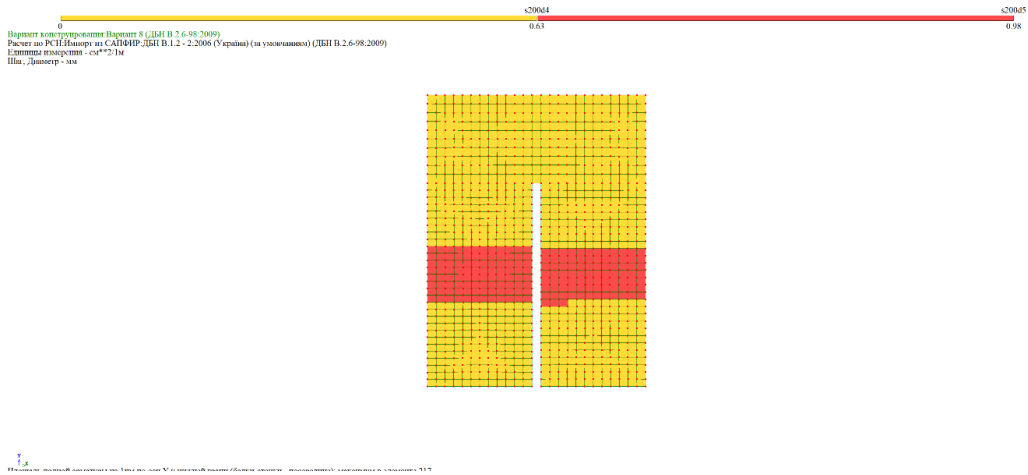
Армування уздовж осі Y біля верхньої грані.
